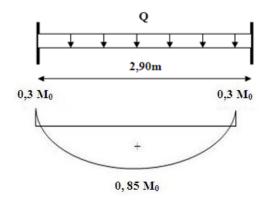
diagramme de la poutre palière à la flexion E.L.U.
